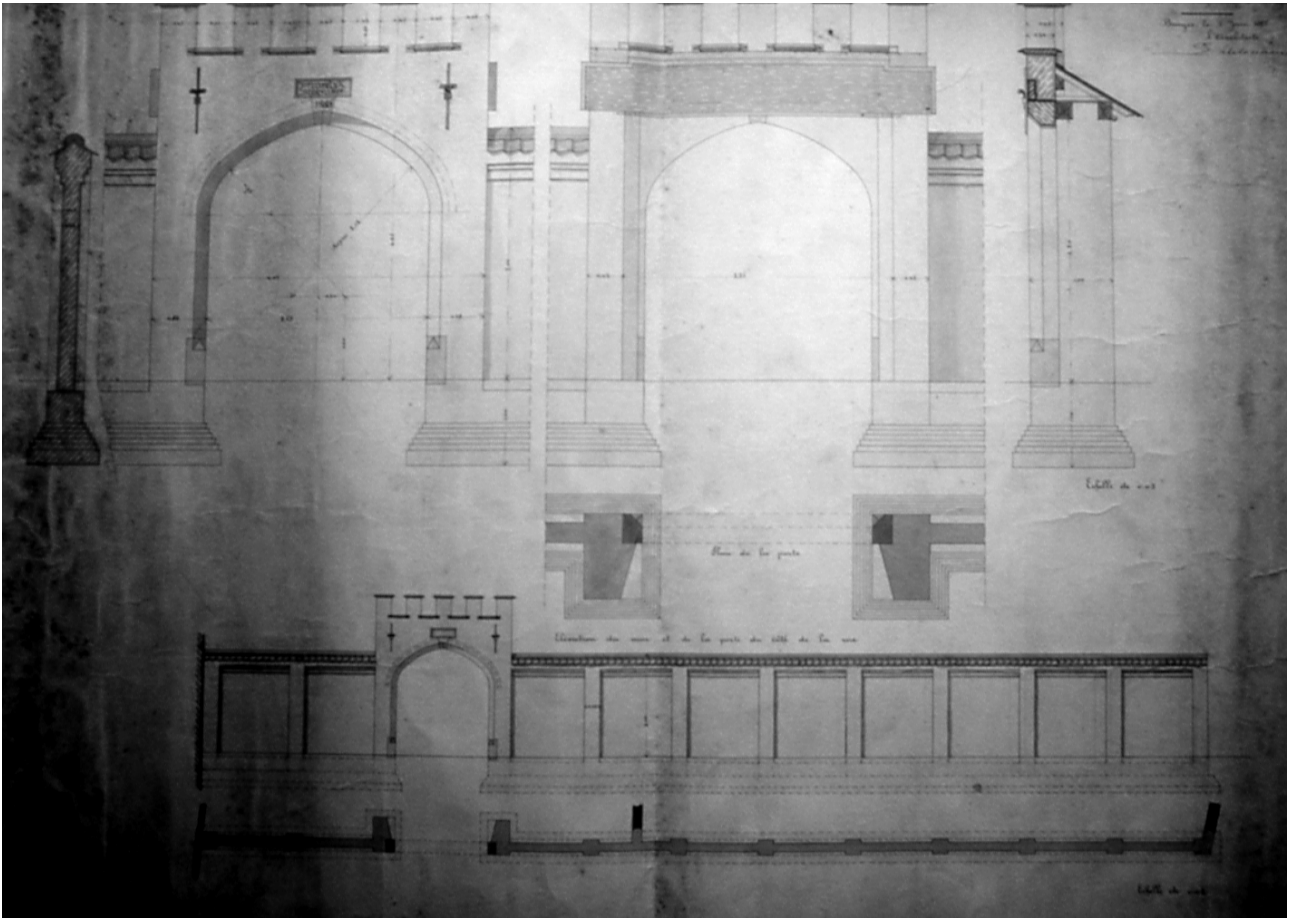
(Brugge, K5) Vermutlich der Plan für den Neubau der an das Minnewater angrenzenden Mauer sowie des (neuen?) Eingangstores. Fotografie des Plan, Copyright Plan OCMW-Archief Brugge.
